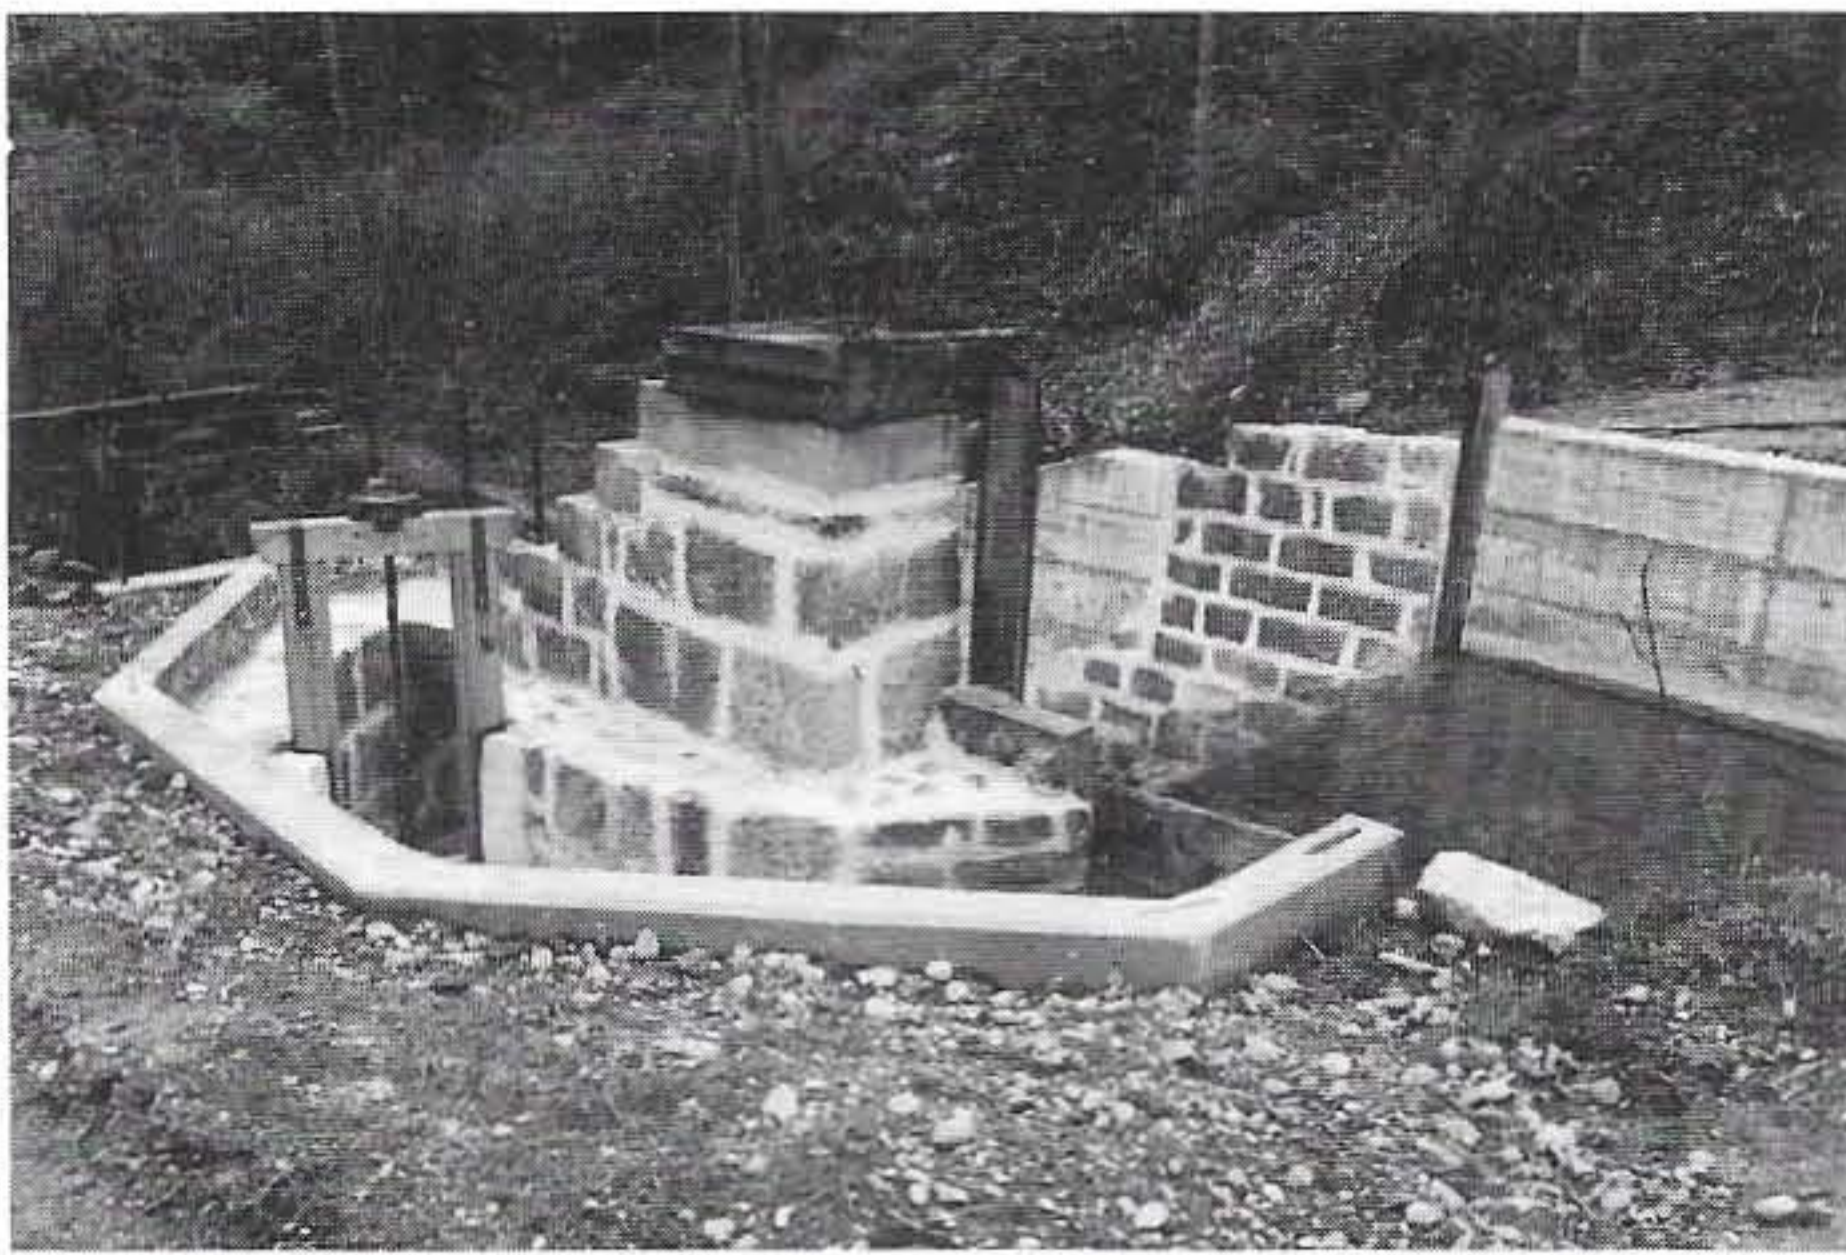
Das Obere Wehr nach der Sanierung 1987.
